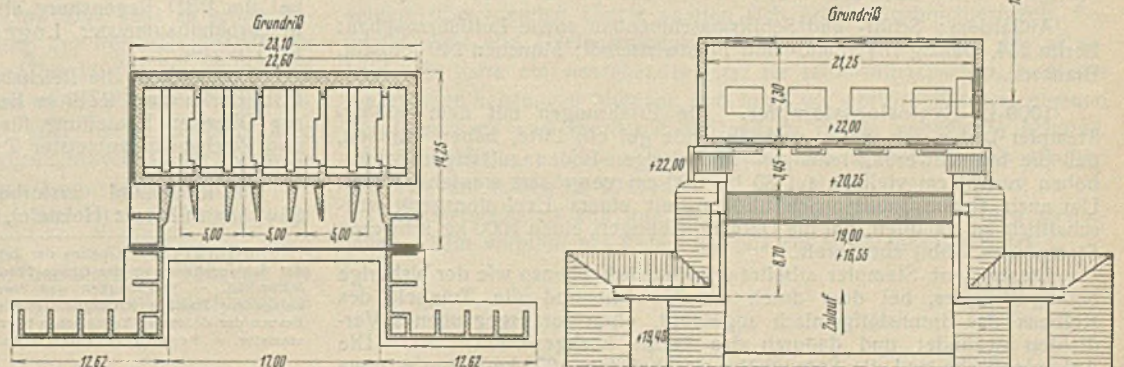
Hebwerk Cartoccio. Grundrisse.
